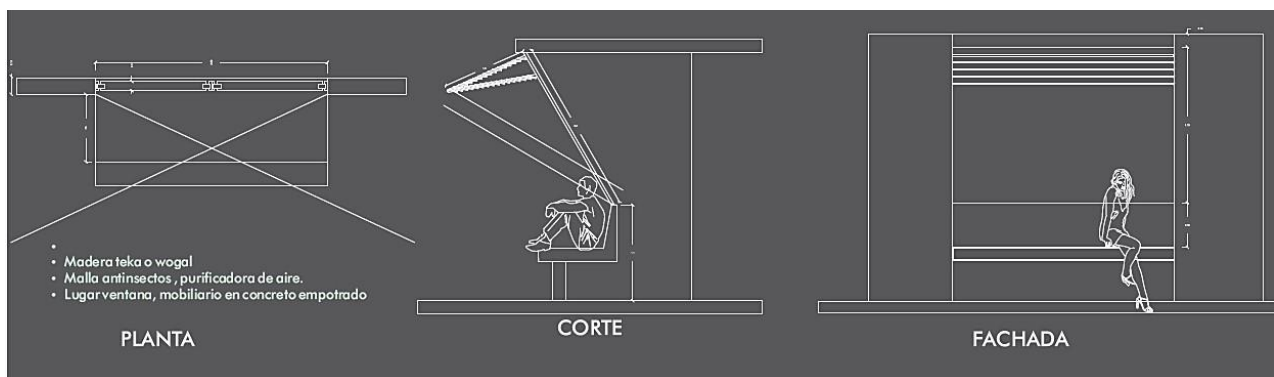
Planimetría Ventana Propuesta, Fuente Elaboración propia 2016.
